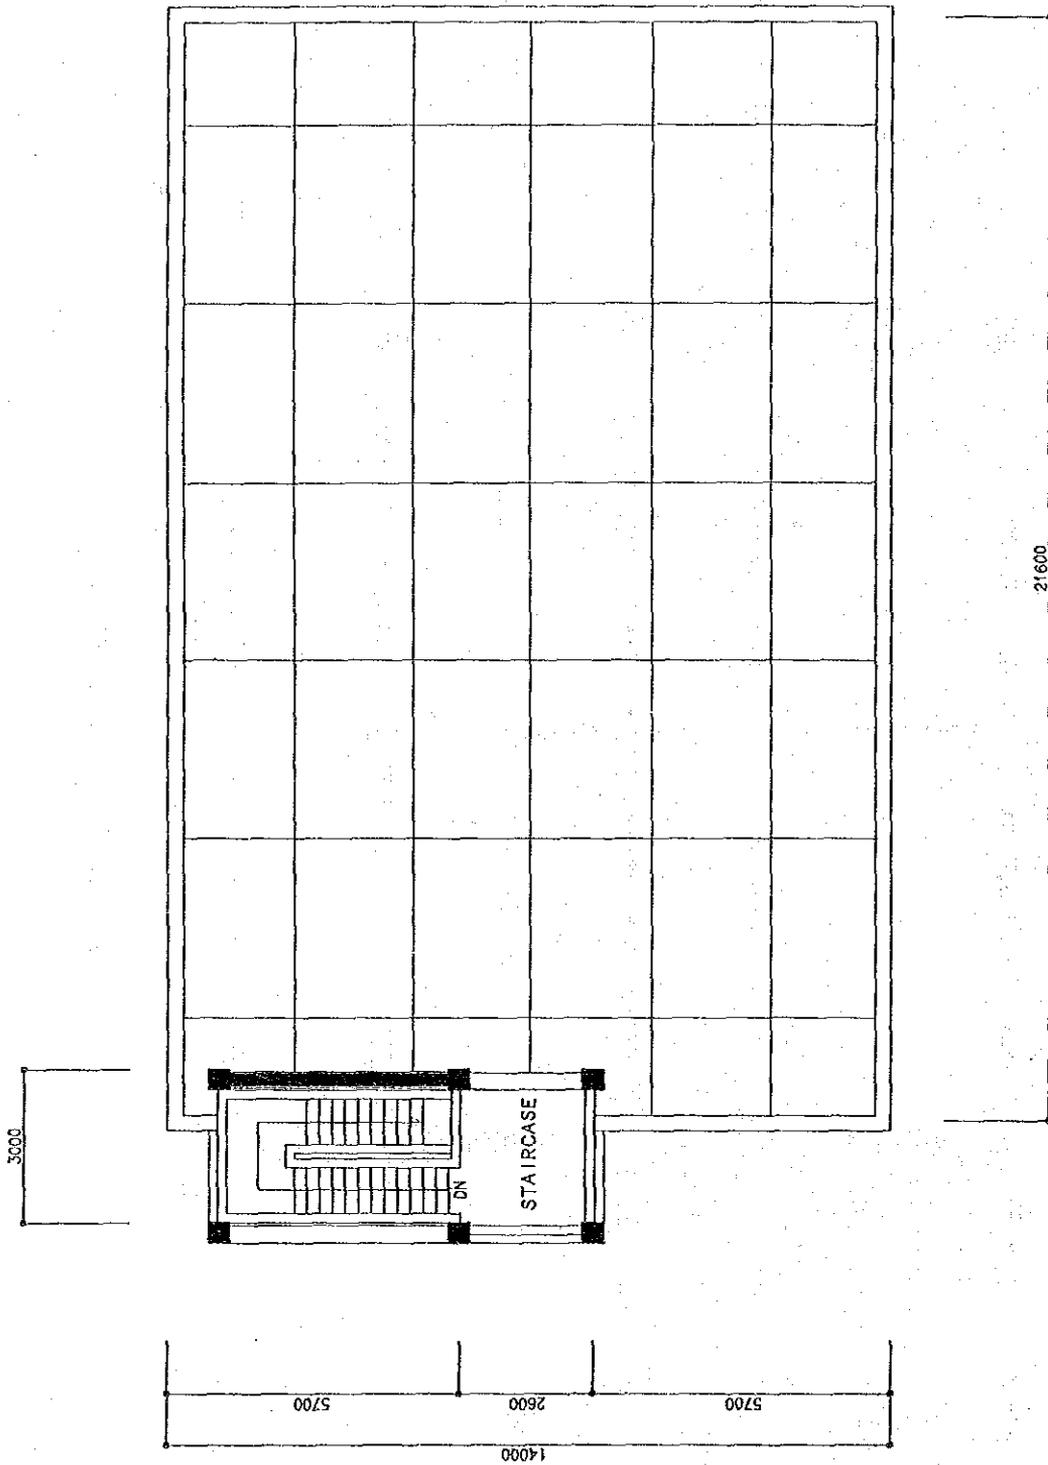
(3) 屋階平面図 (3 教室タイプ)
